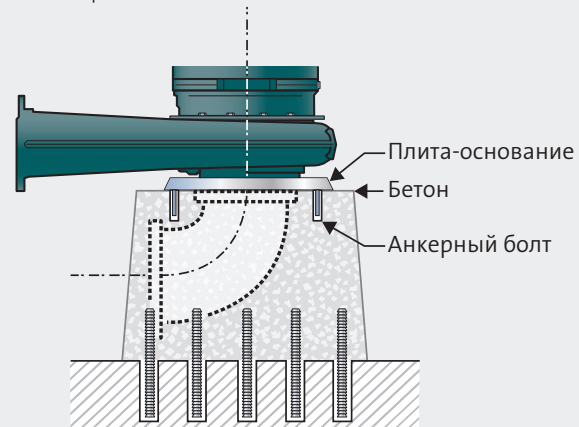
Фундамент с плитой-основанием и анкерными болтами и стяжка между фундаментом и плитой-основанием.
